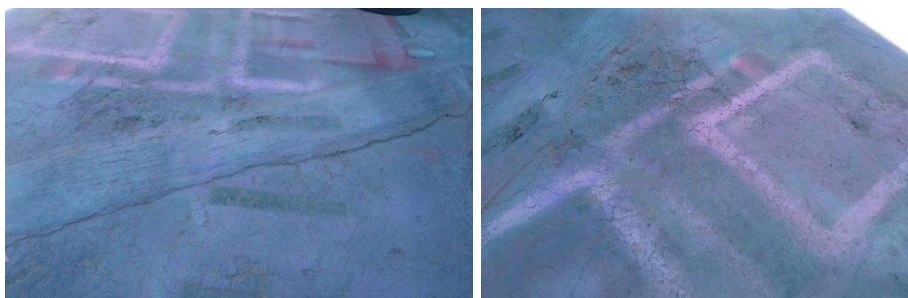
Estado del piso instalaciones microempresa Tu Armario BBB
